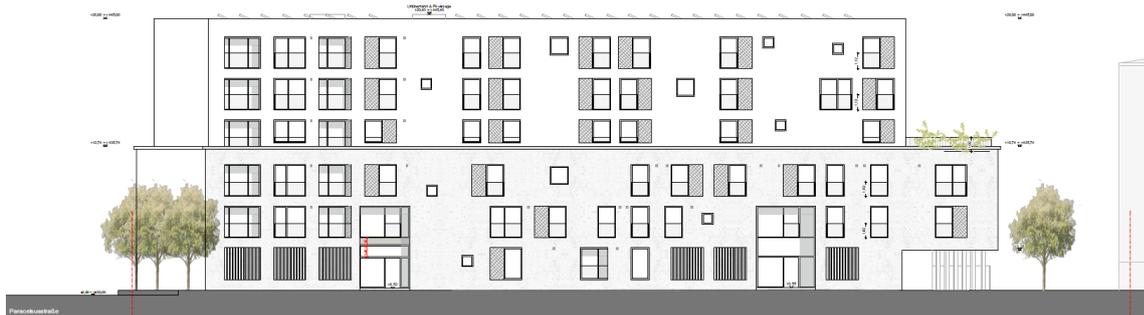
Ansicht West (zur Paracelsusstraße), Darstellung des Planers
